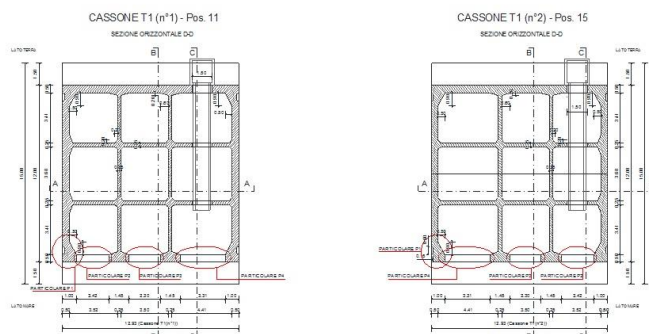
pianta carpenteria (008 062 00SD) disposizione interna celle cassoni T1
